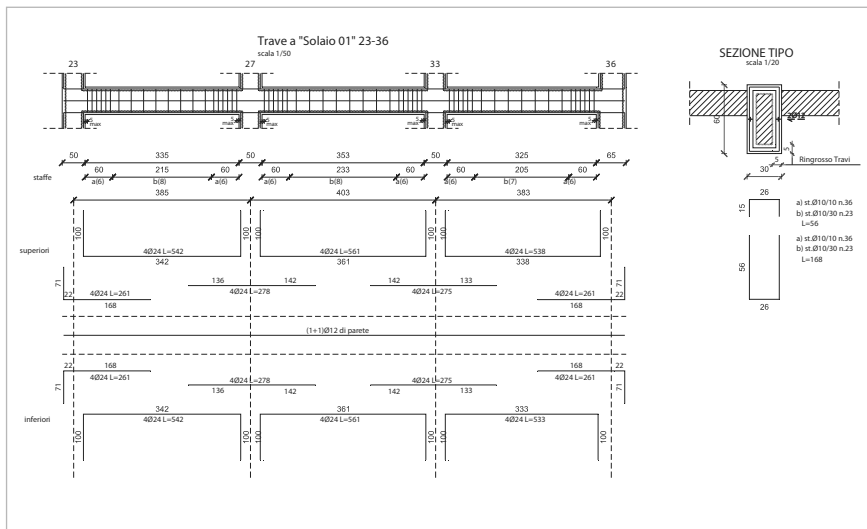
Particolare ringrosso ed armatura trave tipo
